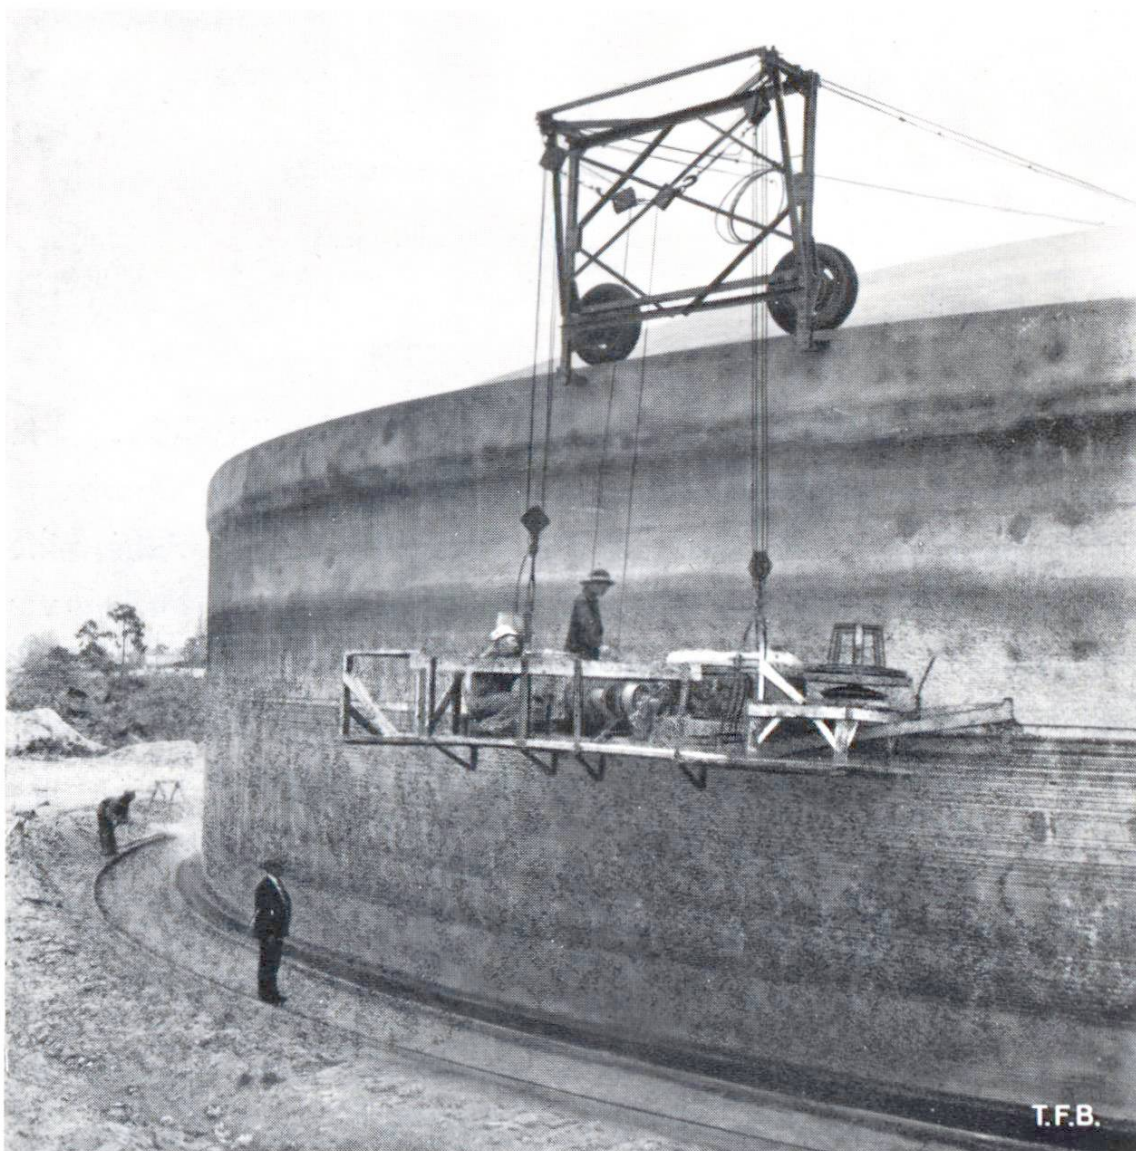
Stahldrahtumwicklung eines Eisenbetonbehälters während der Ausführung
